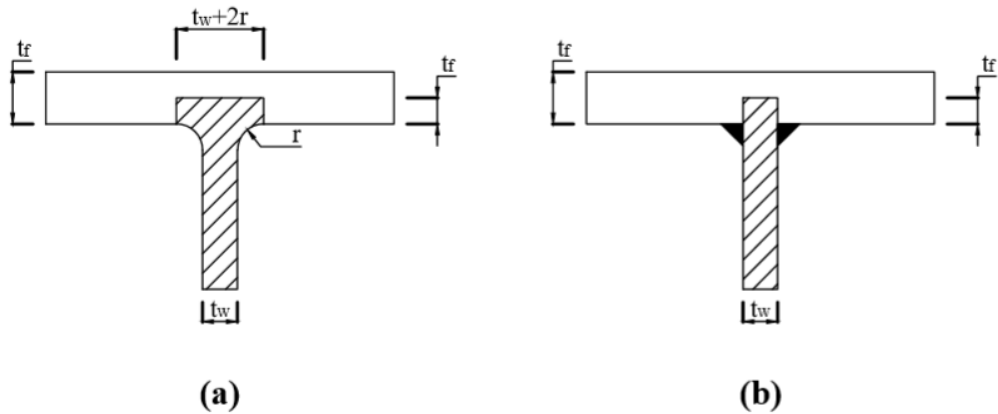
Área da seção resistente ao corte, [33]. (a) Seções laminadas. (b) Seções soldadas.
